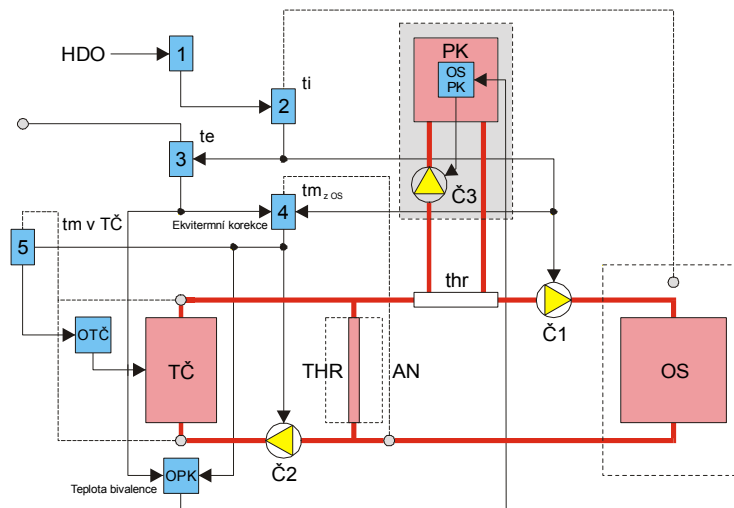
Základní řešení vytápěcího systému s TČ.
